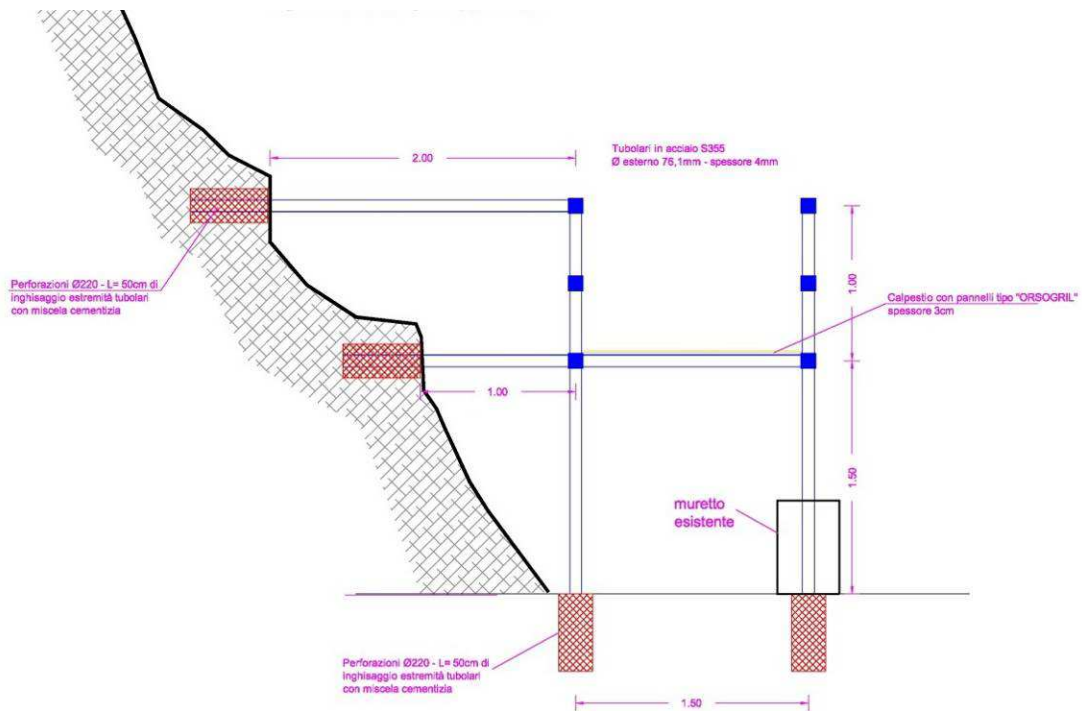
Sezione strutturale tipo della passerella incastrata alla roccia di base e di parete (fronte basso)
